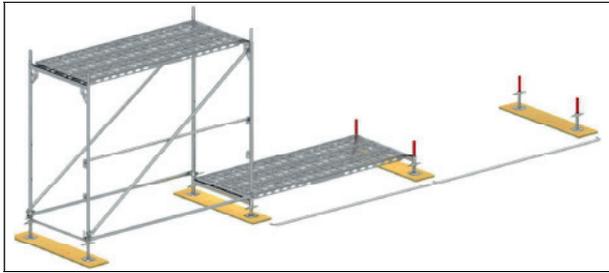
Fertiggestelltes erstes Gerüstfeld eines Gerüstes der Lastklasse ≤ 4 , Ausführung bei geplantem Weiterbau mit Montage-Sicherungs-Geländer
